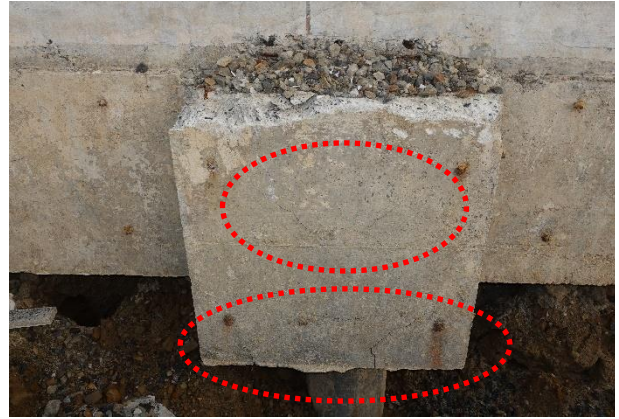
パイルキャップの杭頭近傍位置及びパイルキャップ中央位置でのひび割れ
